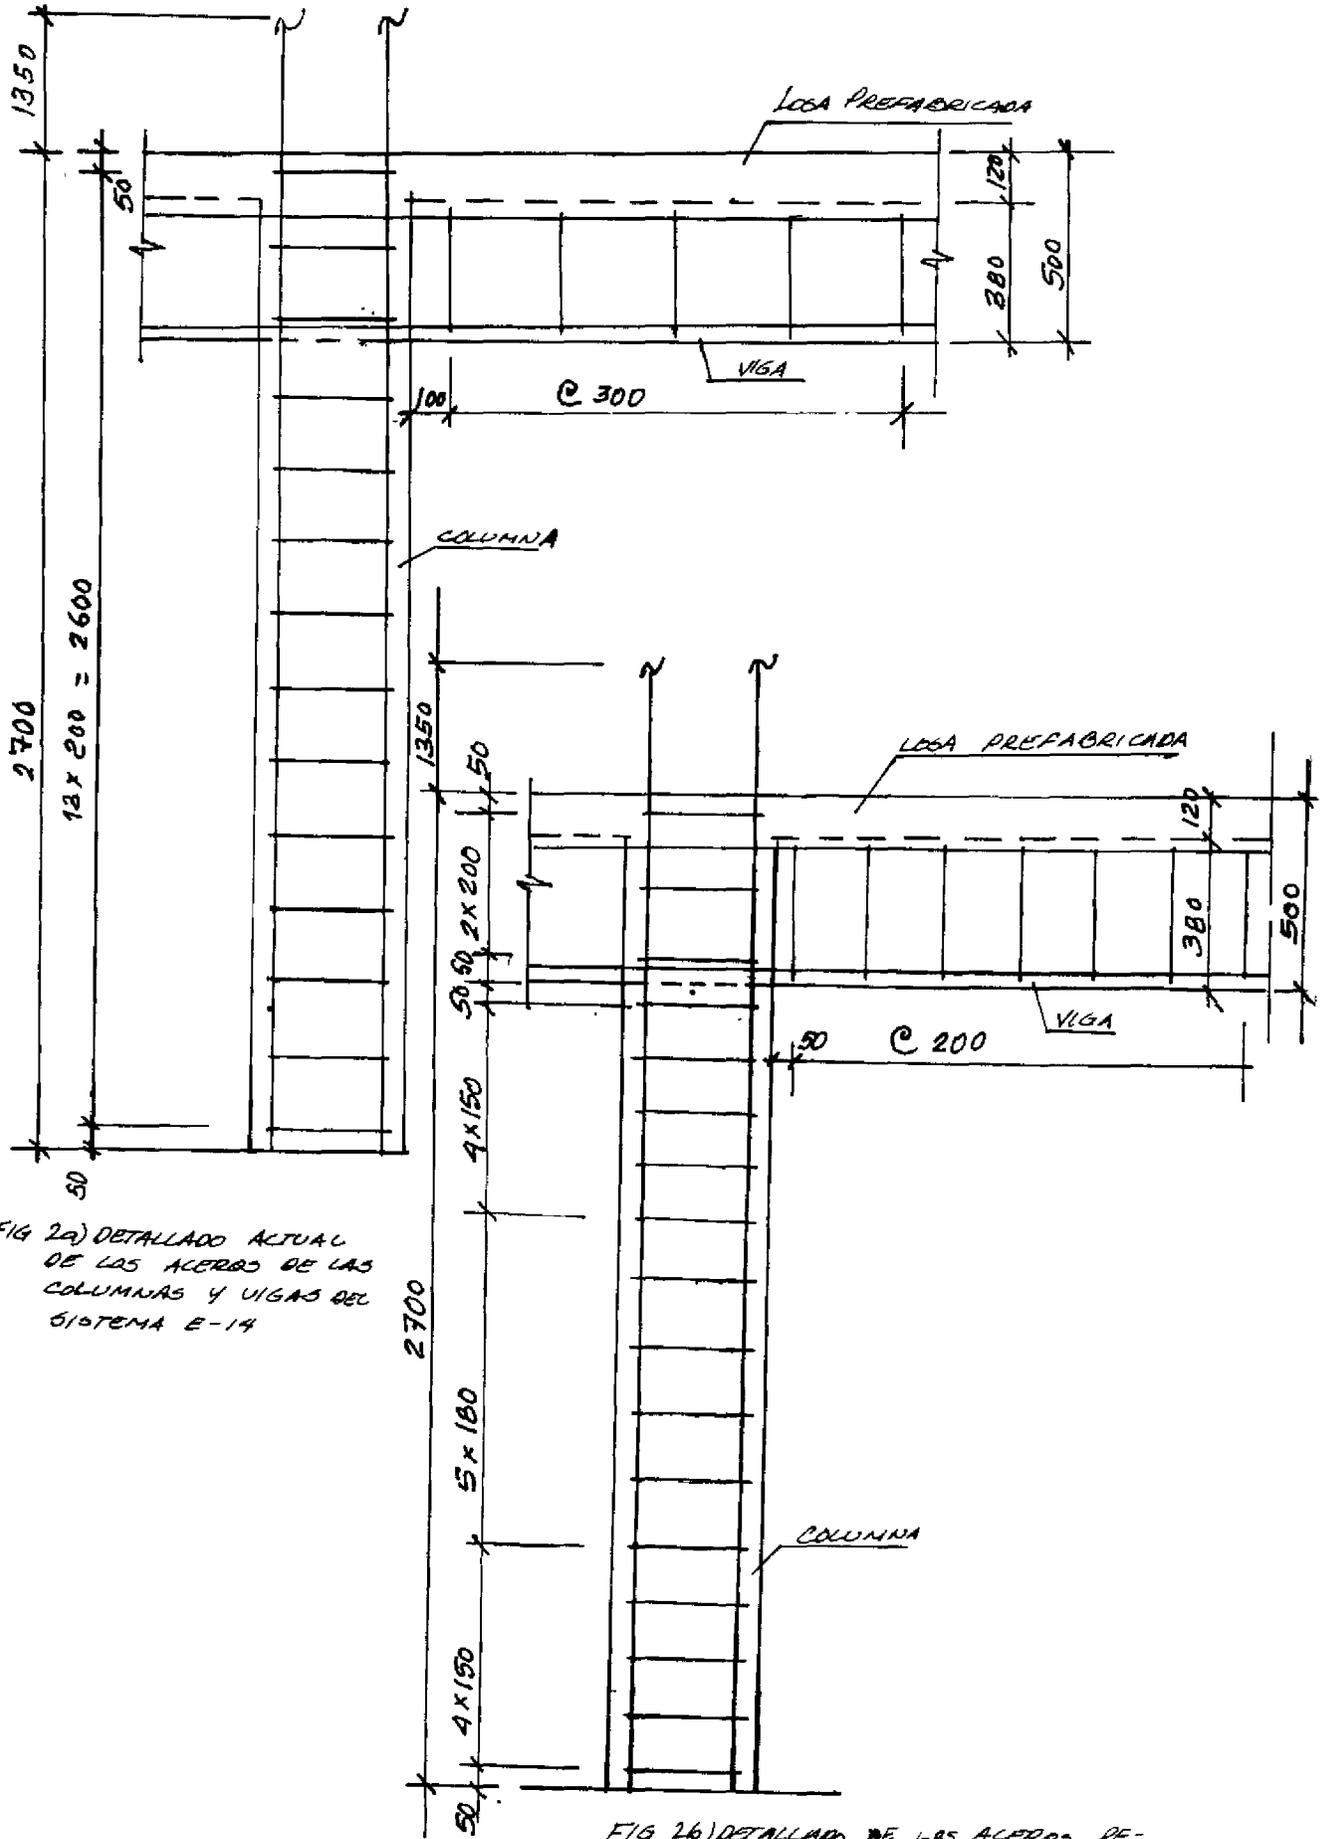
DETALLADO ACTUAL DE LOS ACEROS DE LAS COLUMNAS Y VIGAS DEL SISTEMA E-14
